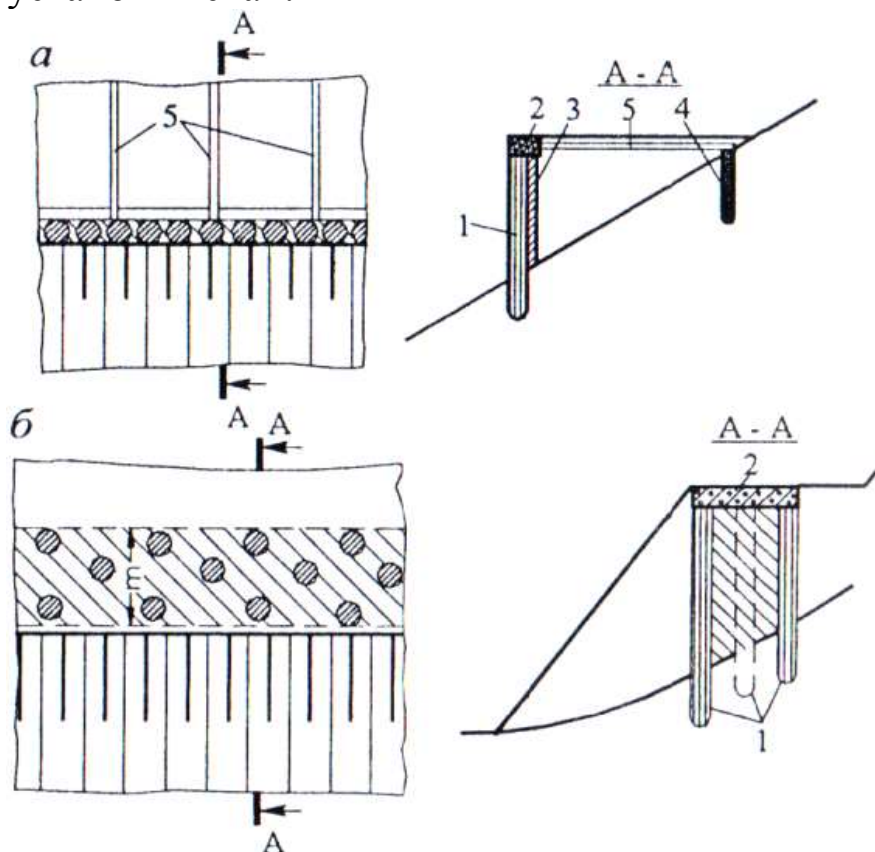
Схемы установки свай: *a* – в один ряд; *б* – в несколько рядов; 1 – свая; 2 – железобетонный ростверк; 3 – затяжка; 4 – анкер; 5 – анкерная тяга
